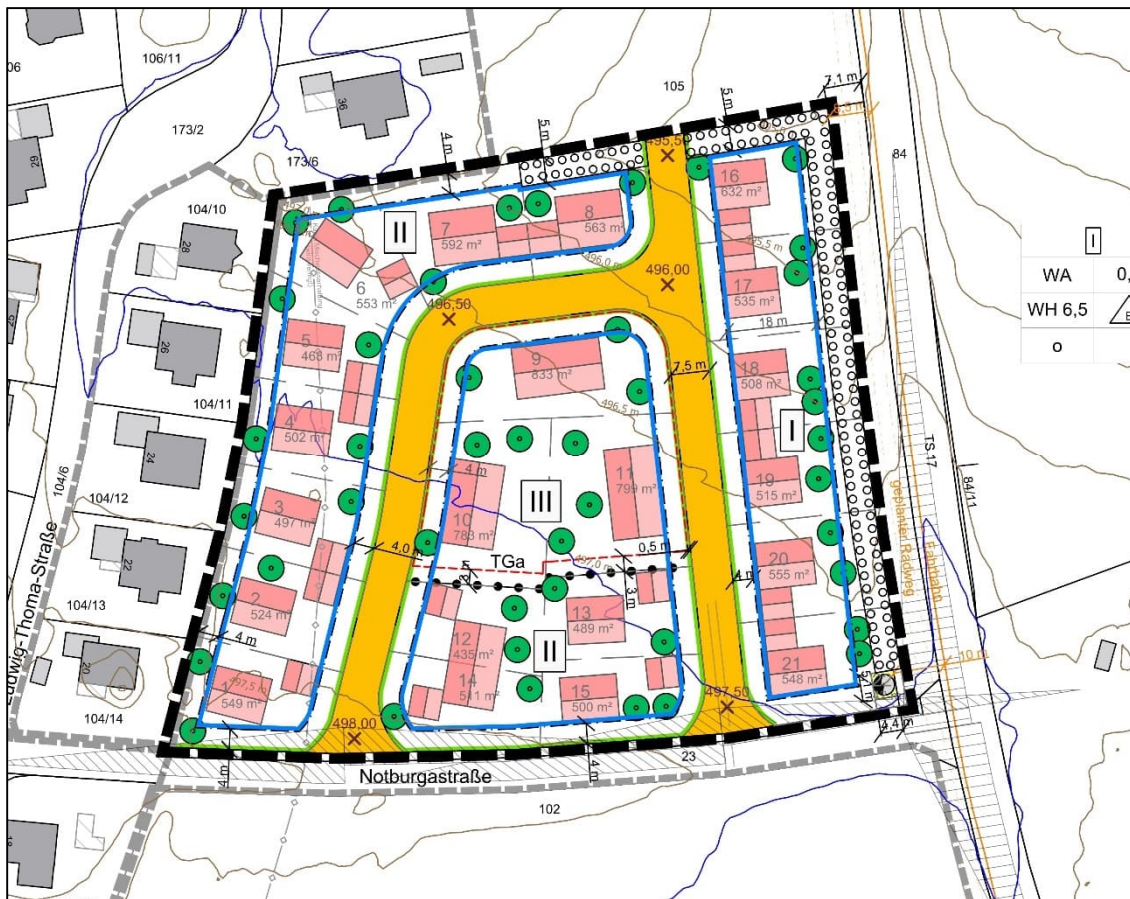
Planzeichnung zum Bebauungsplan "Am alten Pfarrhof Nord" /13/
